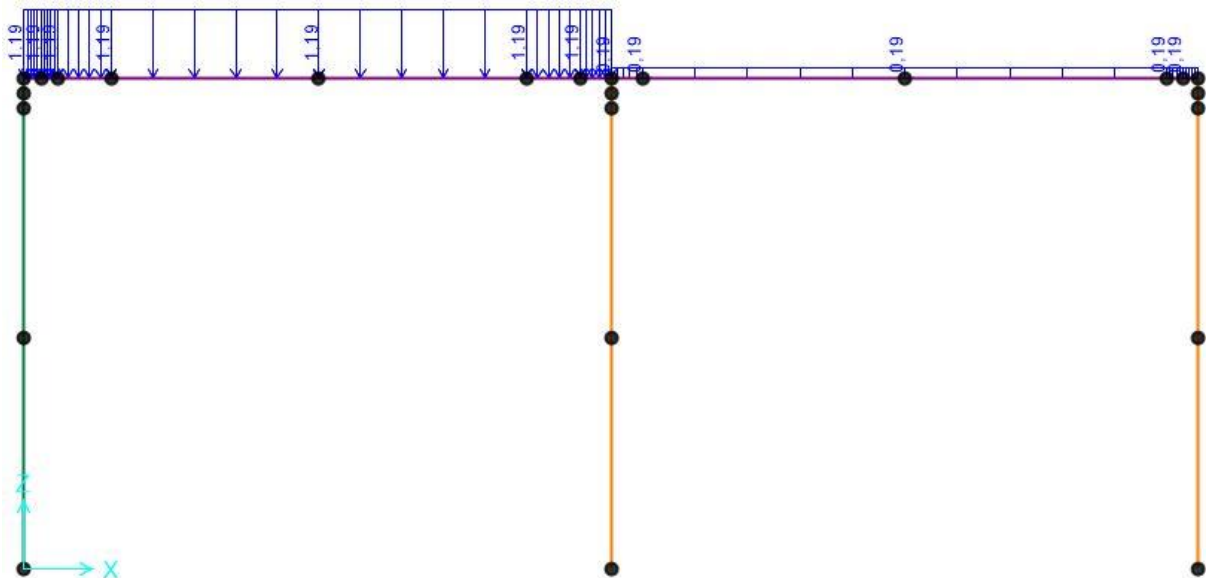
Azione sismica SLV- G2, direzione verticale
